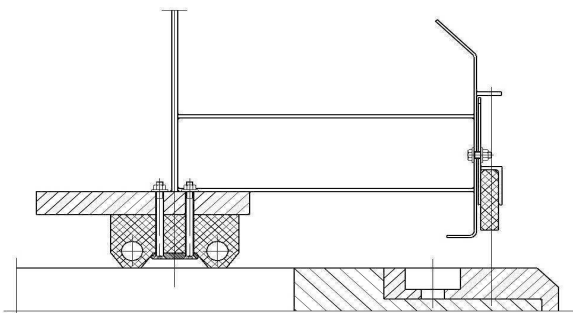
Dichtungssystem Tunnelwand/ Betondrempel
